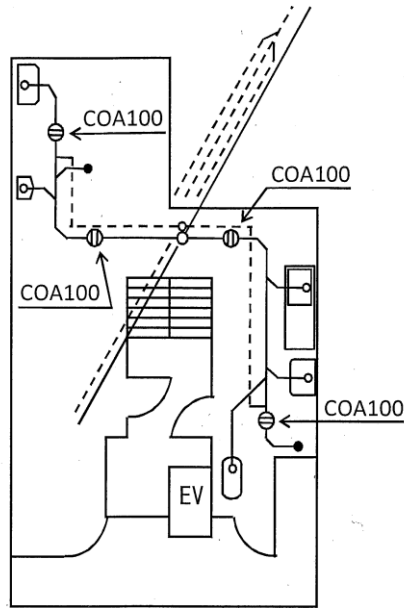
排水設備標準図 (例 2) 平面図縮尺 1/200
